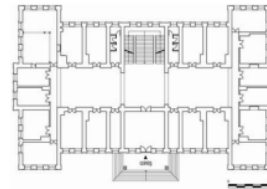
Bolu Hükümet Konağı Planı, 1881
